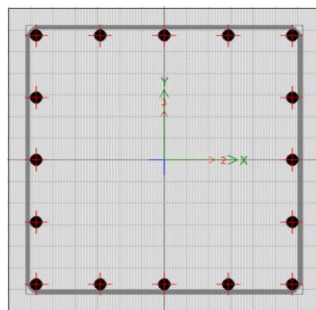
Sección transversal de la columna C22. (Fuente Propia).
